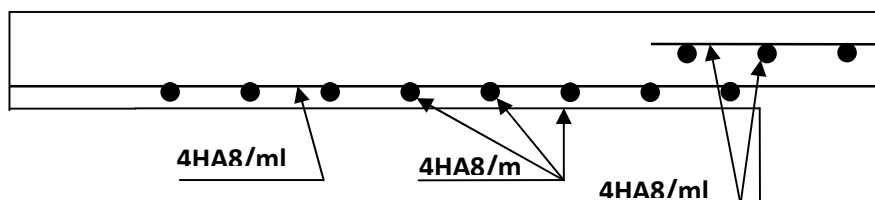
Schéma de ferrailage du premier type de balcon.
